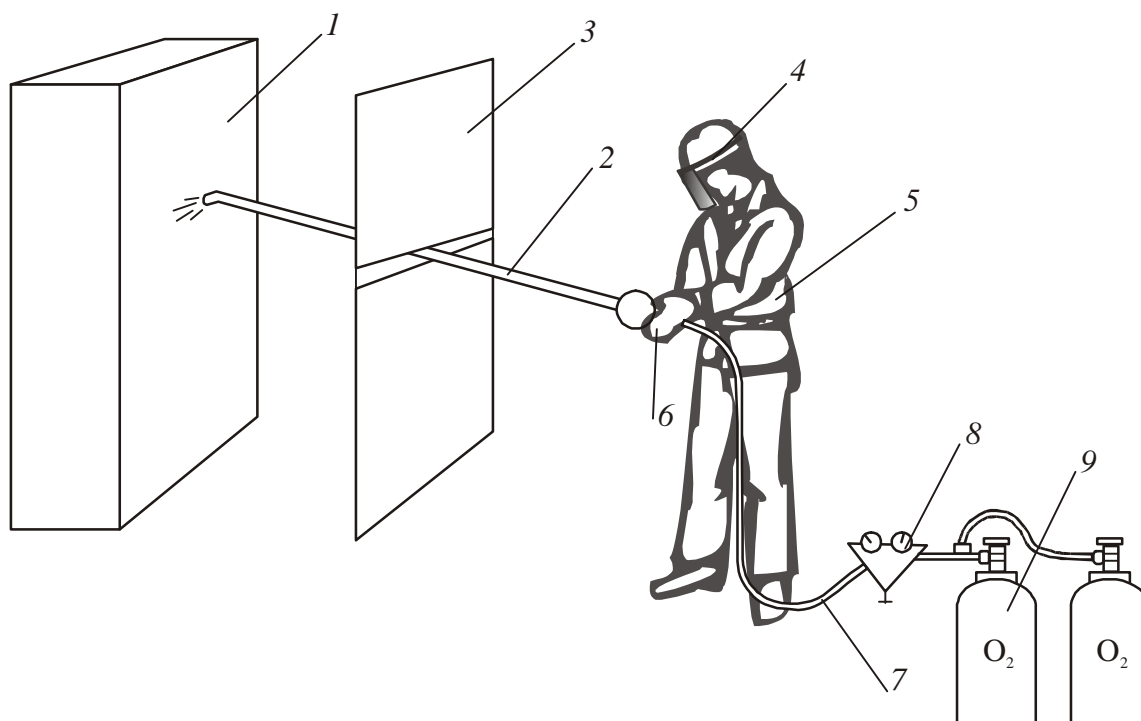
Образование отверстий в конструкции с помощью трубки с сердечником: 1 – конструкция; 2 – трубка; 3 – защитный экран; 4 – защитный шлем; 5 – костюм из алюминизированного асбеста; 6 – асбестовые перчатки; 7 – бронированный шланг; 8 – редуктор; 9 – баллоны с кислородом
